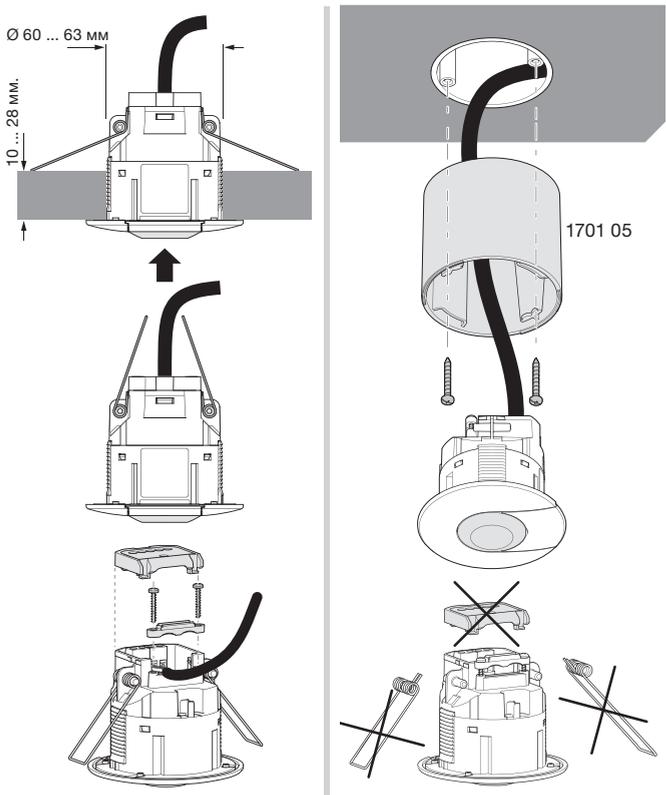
Монтаж в подвесной потолок / в коробку для наружного монтажа 1701 05
